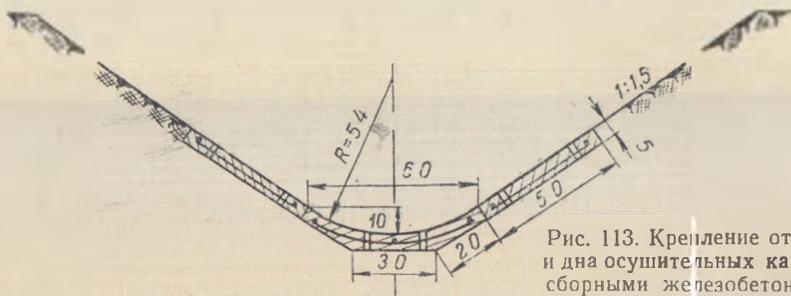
Крепление откосов и дна осушительных каналов сборными железобетонными элементами.
